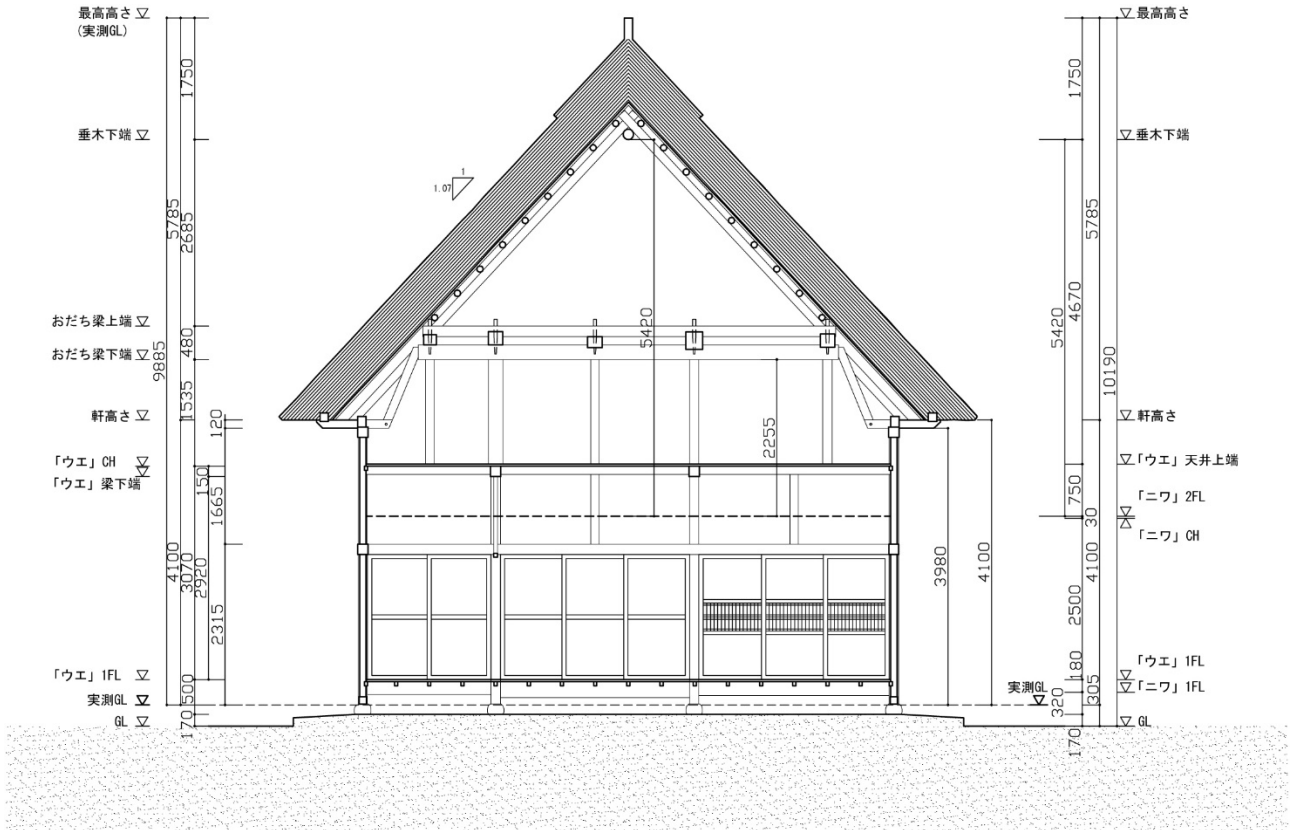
黒谷旧船木家 主棟梁行方向断面図 1/100
